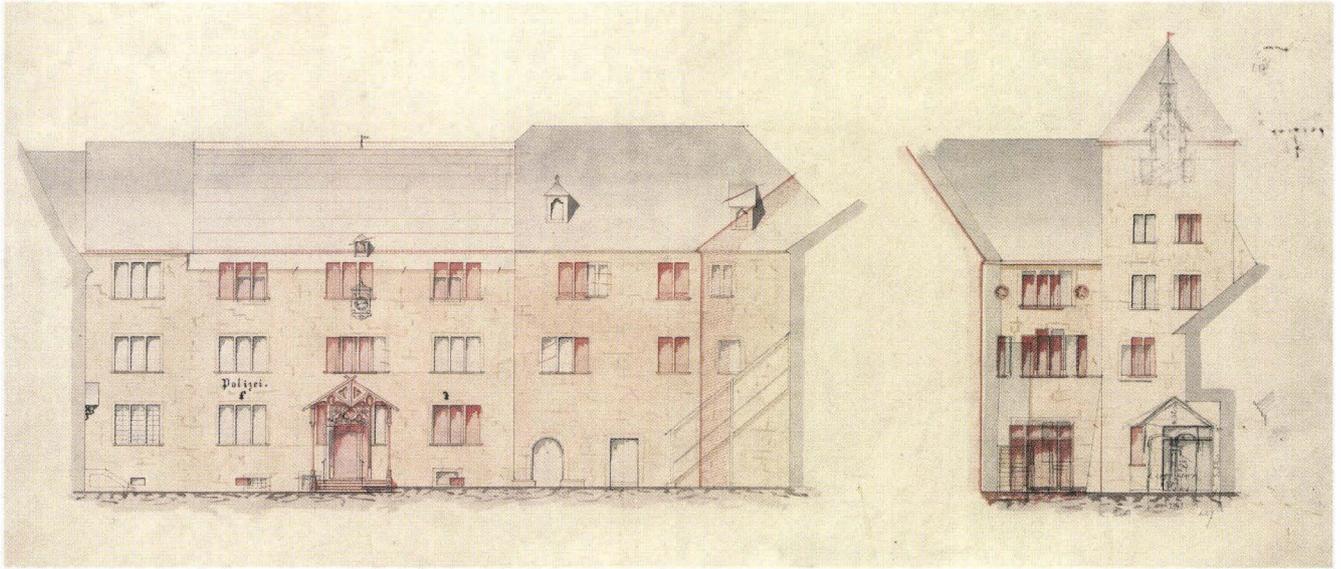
Lohnhof. Die Nordfassaden der südlichen Gebäude, Plan aus der Bauzeit 1852–55. Der Abschnitt rechts (Ostfassade des Uhrturms) wurde nicht wie dargestellt ausgeführt. – Planarchiv StABS D 2, 59.
